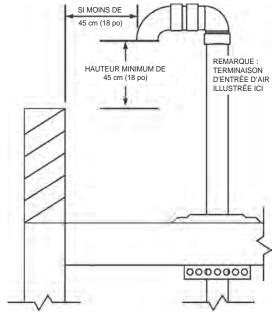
Dégagement d'une admission sur toit plat par rapport à des structures proches
